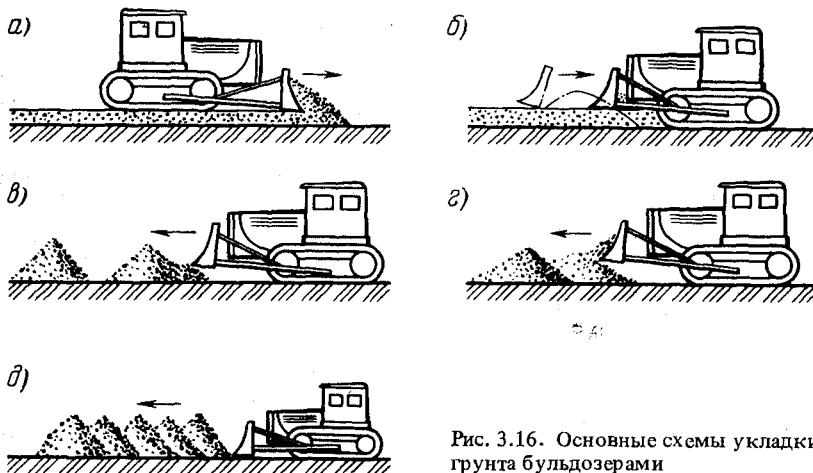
Основные схемы укладки грунта бульдозерами
